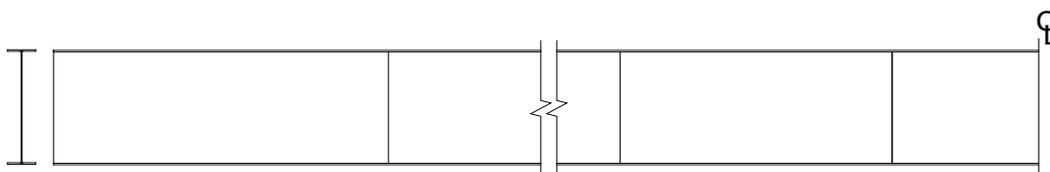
Esquema de viga de rigidez (Véase Planos Anexo VII)
